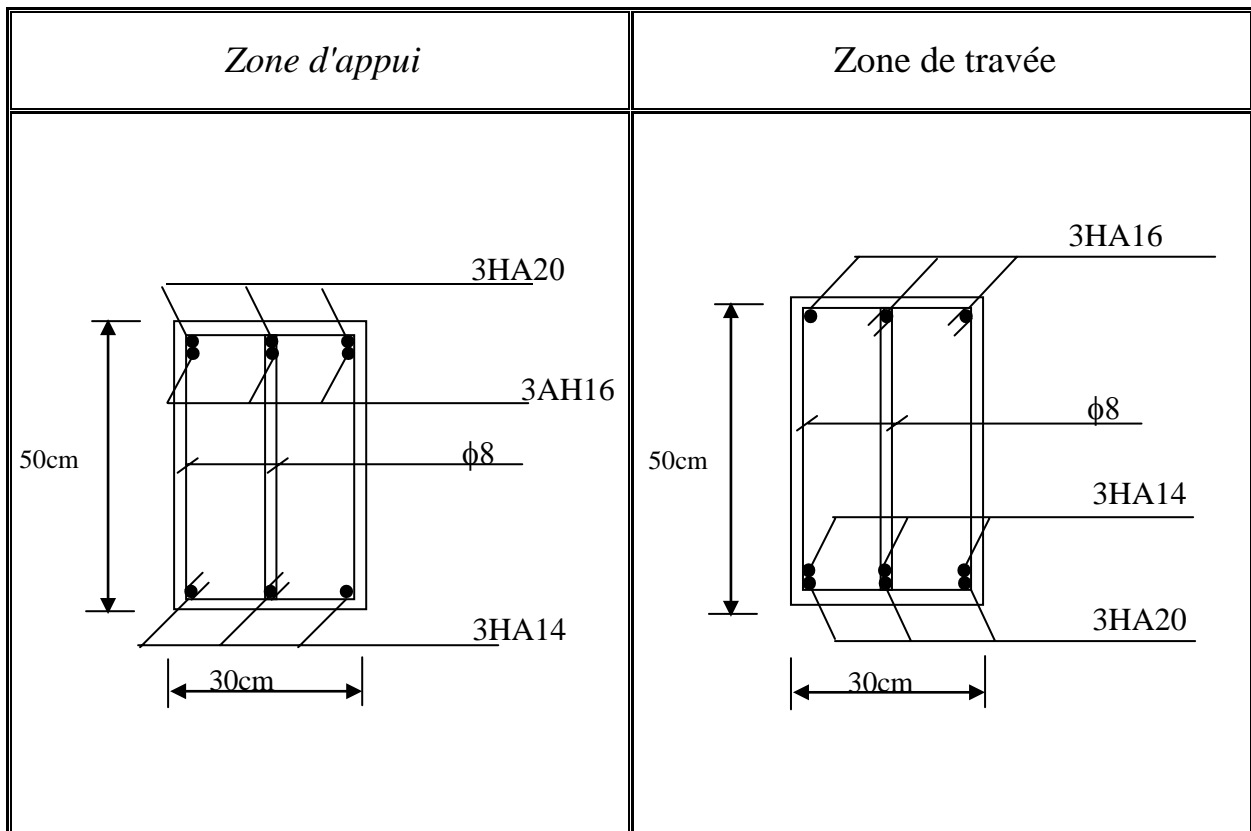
Croquis de ferrailages des poutres principales.
